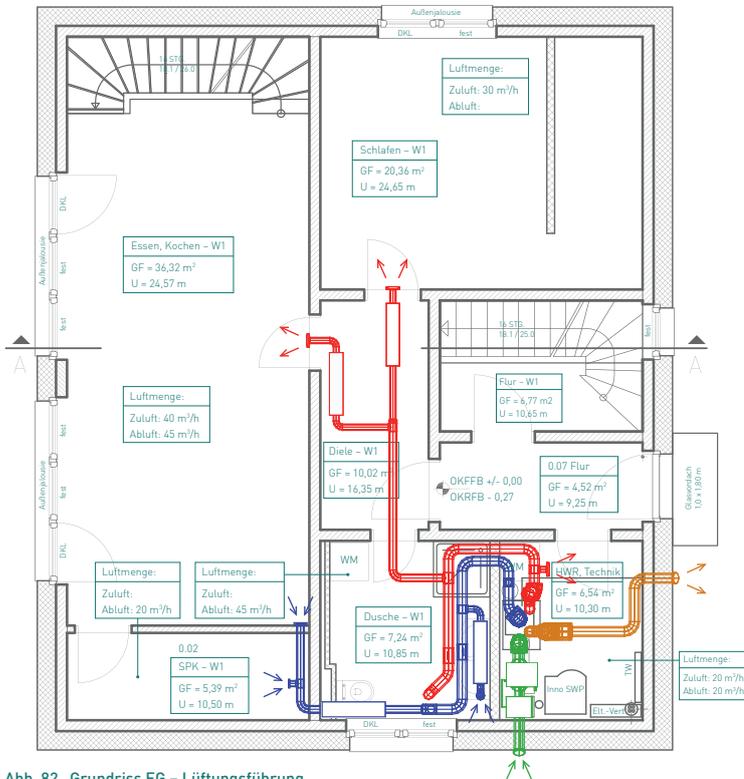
Grundriss EG – Lüftungsführung
